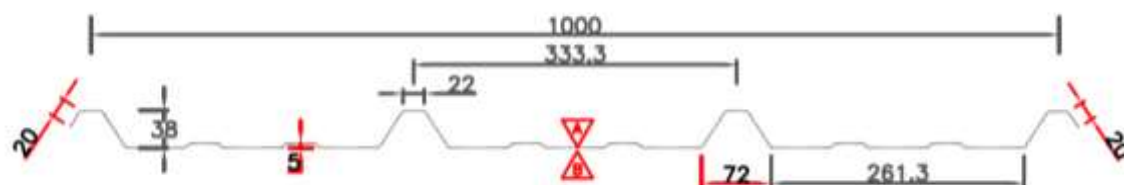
Sezione trasversale del profilo trapezoidale.
